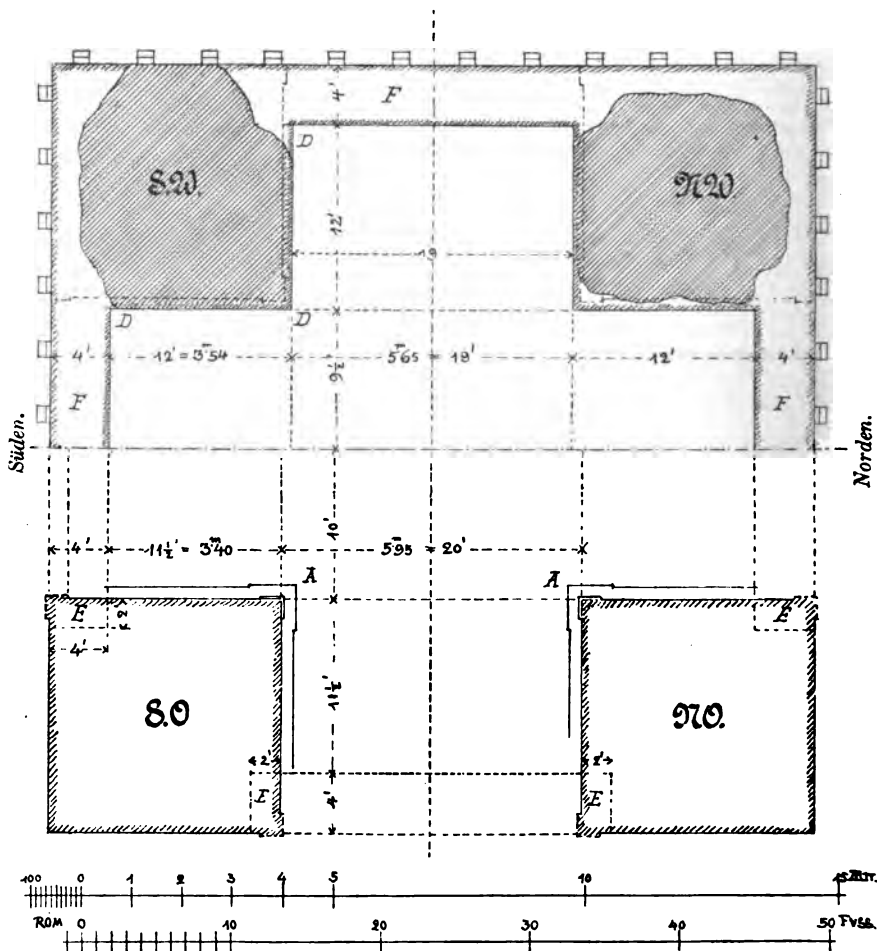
Heidenthor: Grundriss im Straßenniveau.
